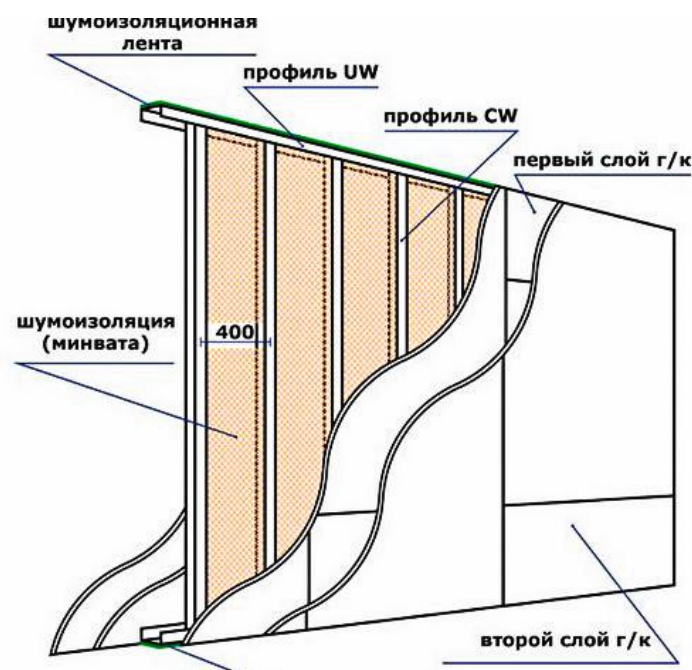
Схема монтажу міжкімнатні перегородки з ГКЛ
